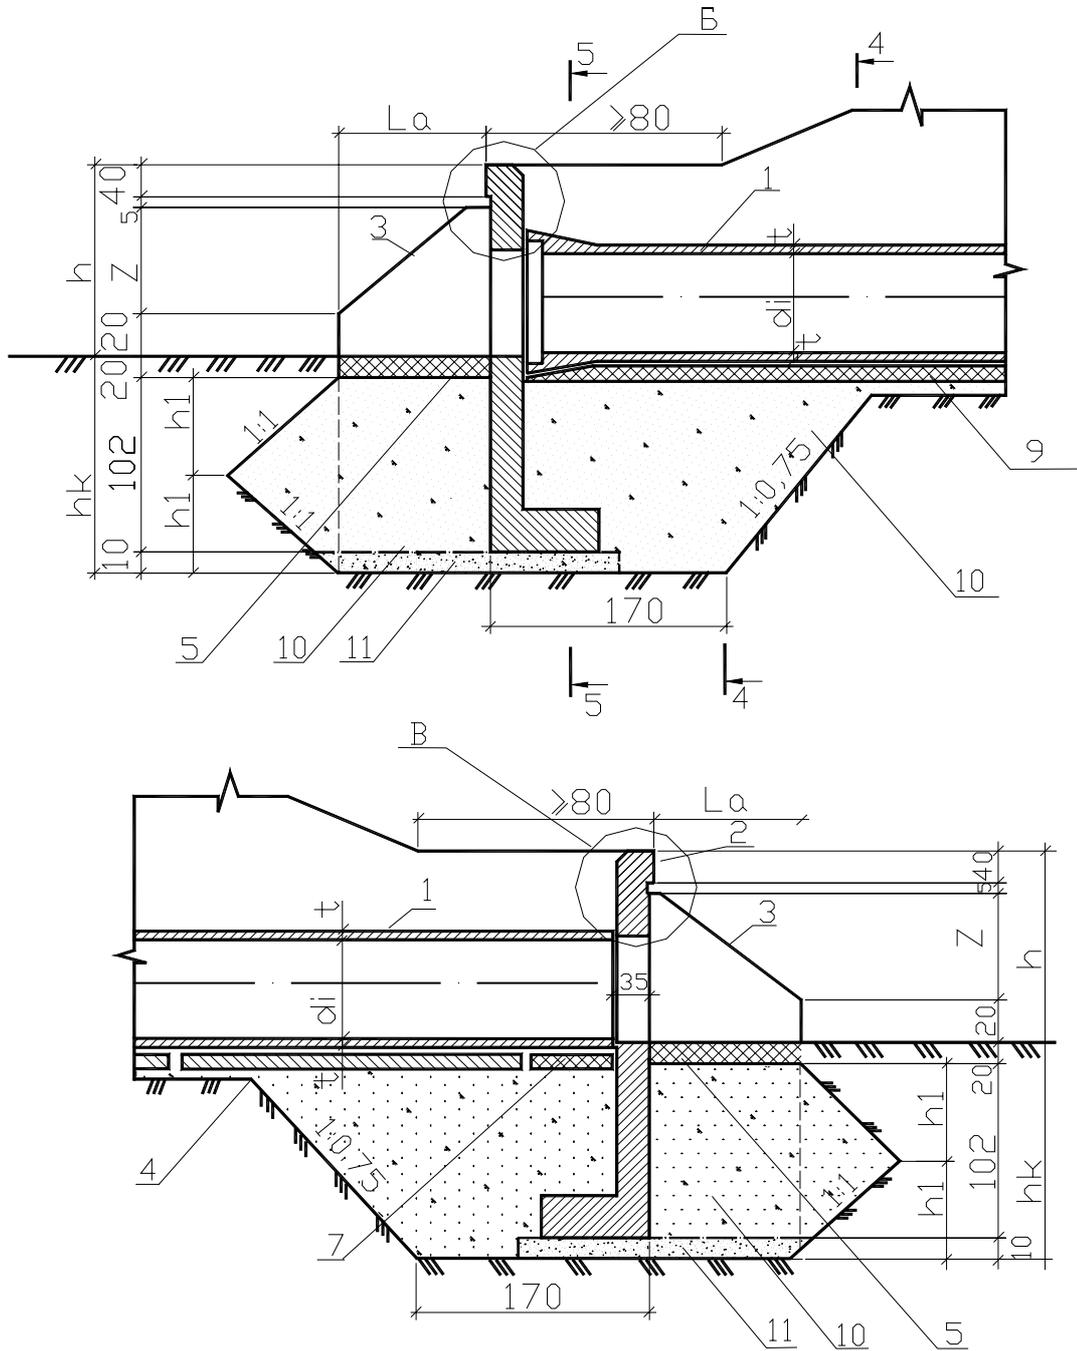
Продольный разрез оголовка трубы с монолитными фундаментами; со сборными фундаментами: а) на входе; б) на выходе; 1 – звено трубы; 2 – порталная стенка; 3 – откосные крылья; 4 – блок фундамента; 5 – монолитный бетон В20 лотка; 7– участок монолитный УМ2 из бетона В20; 11 – подготовка из щебня или гравия; 10 - гравийно-песчаная подушка; 9- бетон фундамента В 20.
